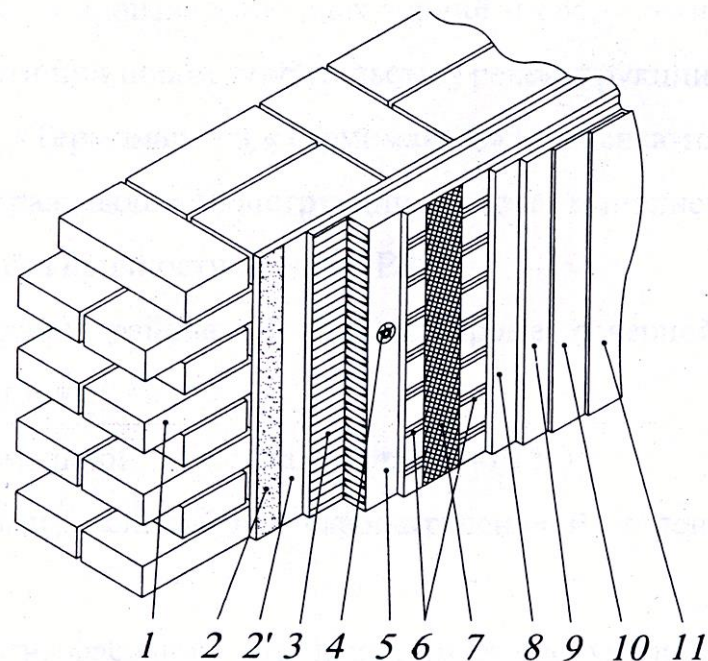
Схема системы фасадной теплоизоляции Caparol.
